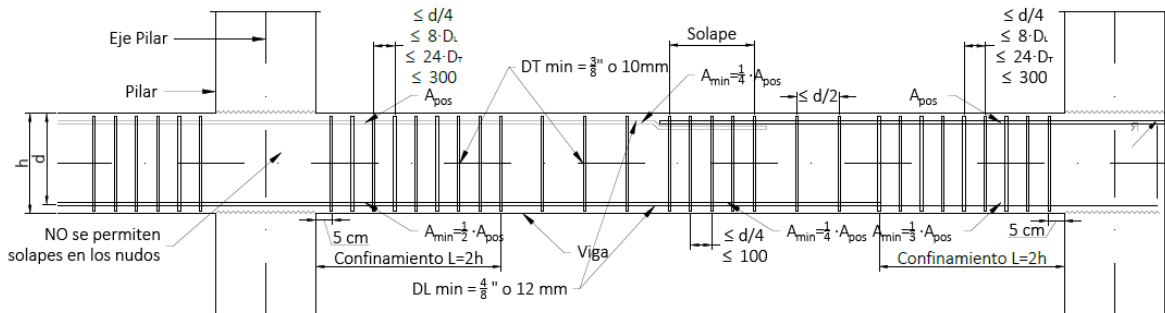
Detalle longitudinal estructural de VIGA para ductilidad DES
